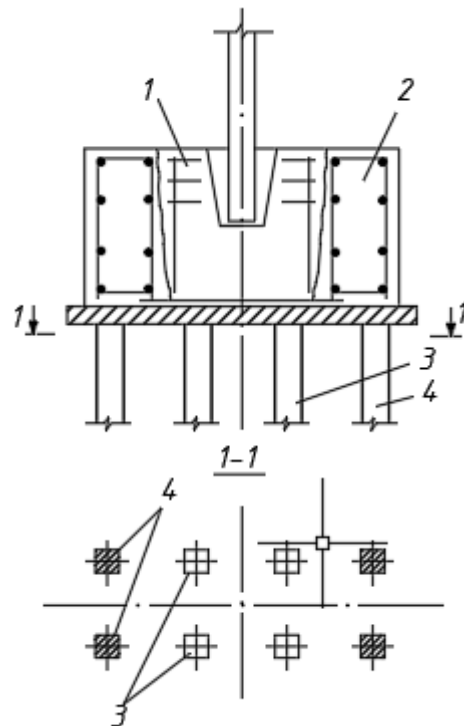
Підсилення фундаменту ростверком, розташованим в межах висоти фундаменту: 1 - підсилений фундамент; 2 - ростверк підсилення; 3 - існуючі палі; 4 - палі підсилення
